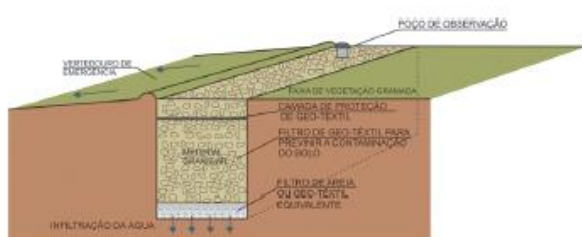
Esquema e exemplo trincheiras de infiltração e de retenção.
